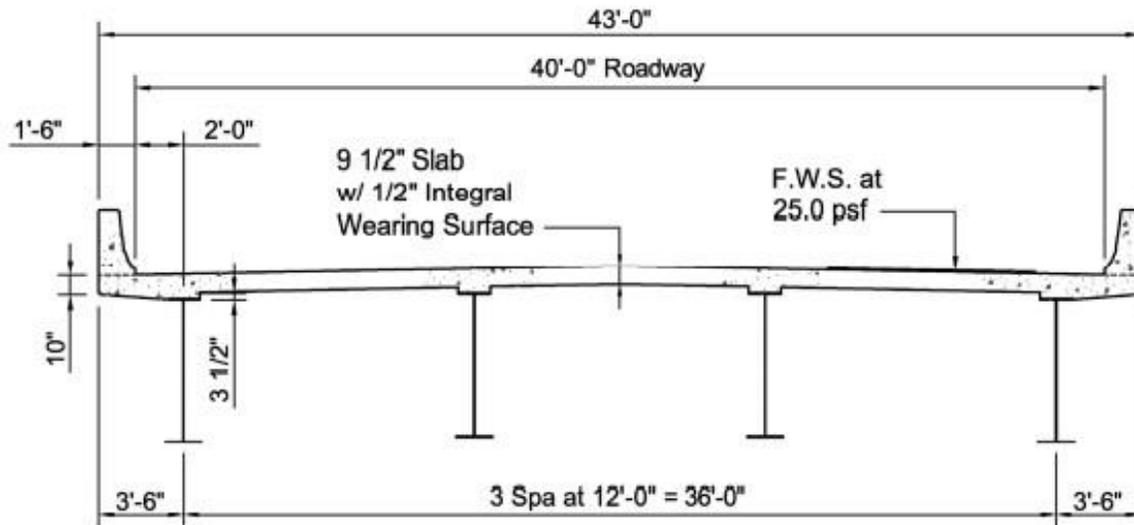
Ejemplo de viga tipo i compuesta recta continua de tres tramos
